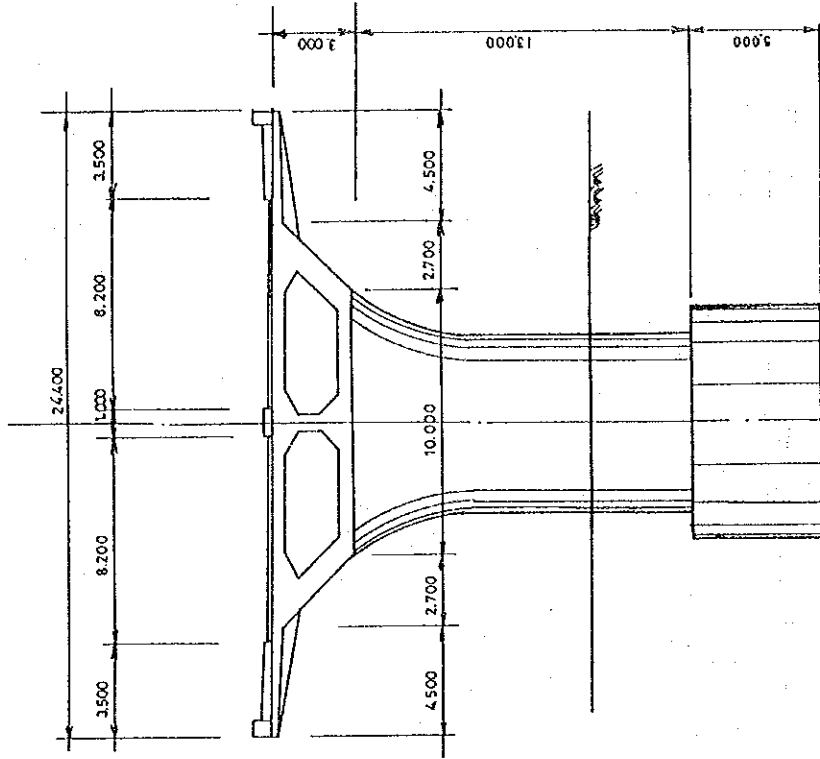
Puente de Viga Continua Tipo Cajón,
